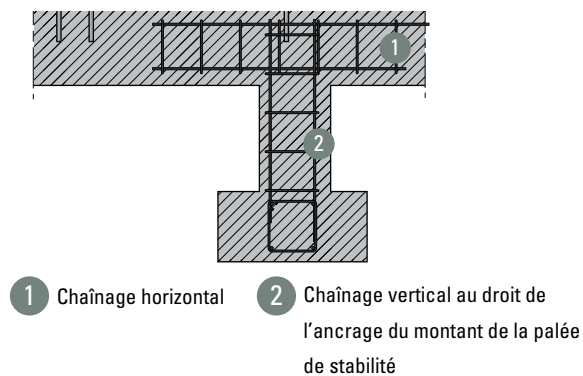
Exemple d'assemblage entre structure légère et fondations (2)
